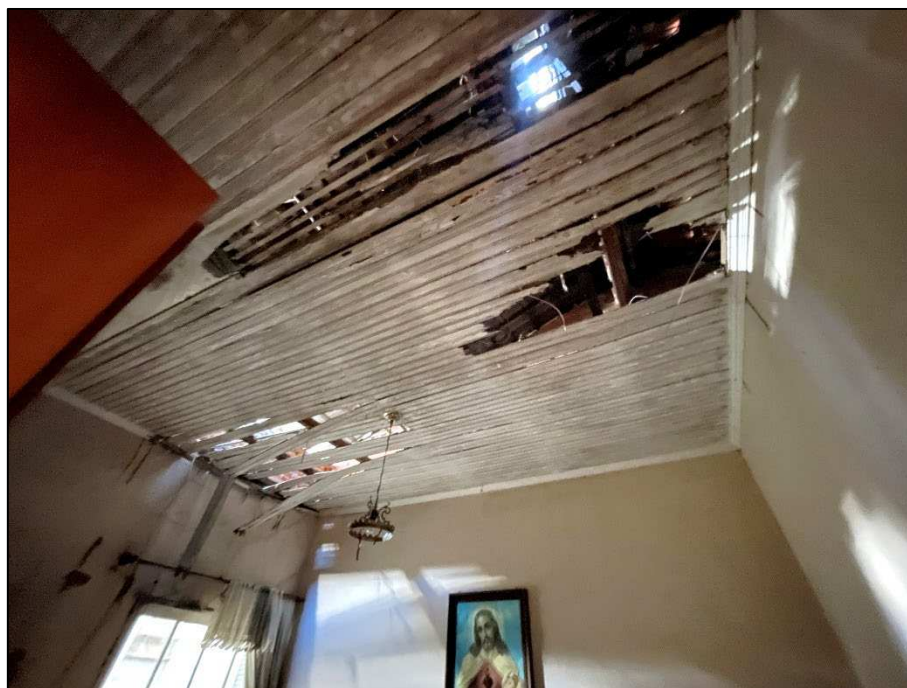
Rua Riachuelo, n.º 88 – Forro do Dormitório
